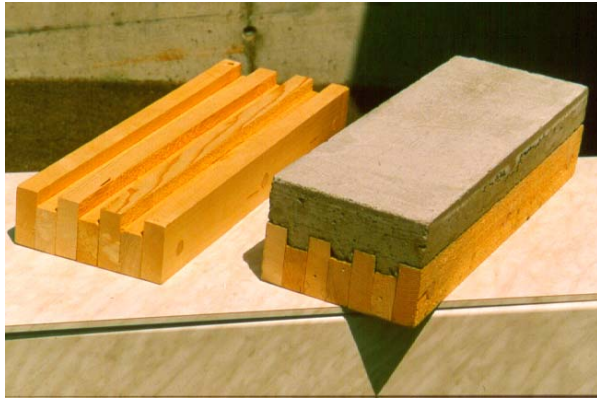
Modell einer HBV-Decke mit dem Verbundsystem der sägerohen Holzoberfläche
